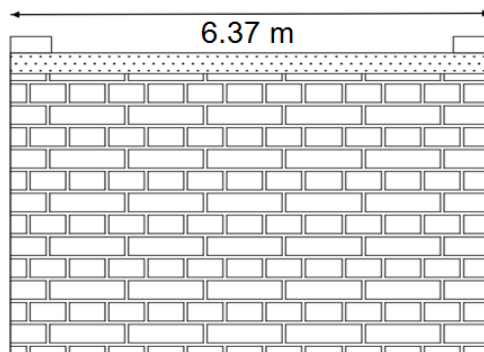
Corte transversal puente de mampostería de ladrillo La Concordia.
